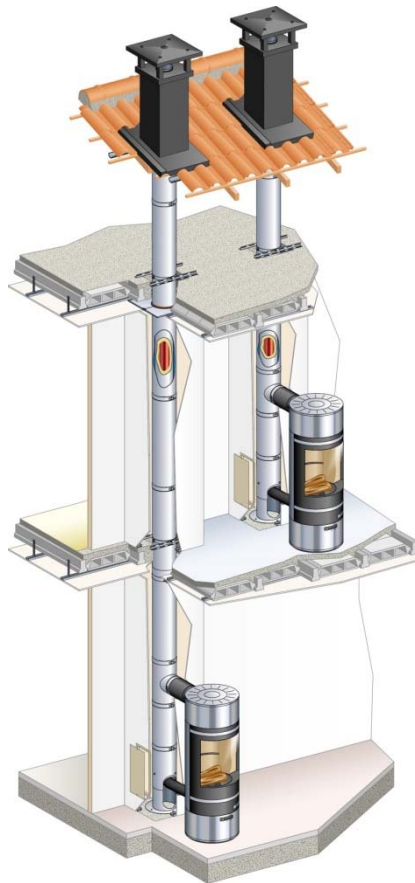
Conduit système EFFICIENCE® avec conduit de raccordement « émaillé » ou « 2 mm » sur le dessus de l'appareil avec ou sans coffrage ventilé
